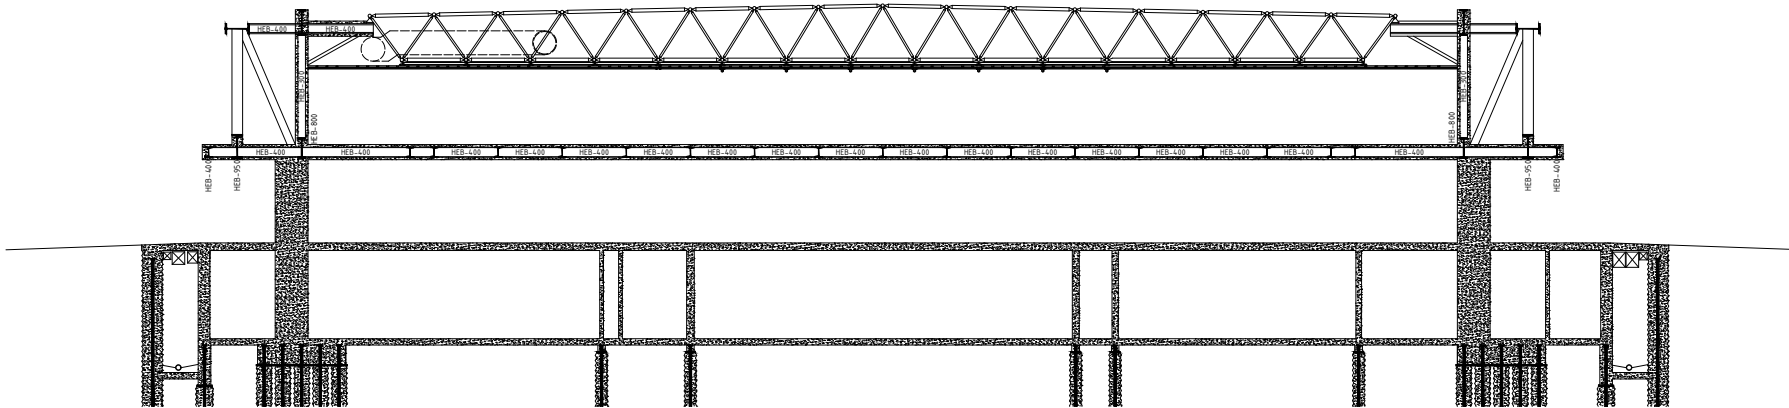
Sección estrutural transversal do Centro Cultural. Escala 1/300
